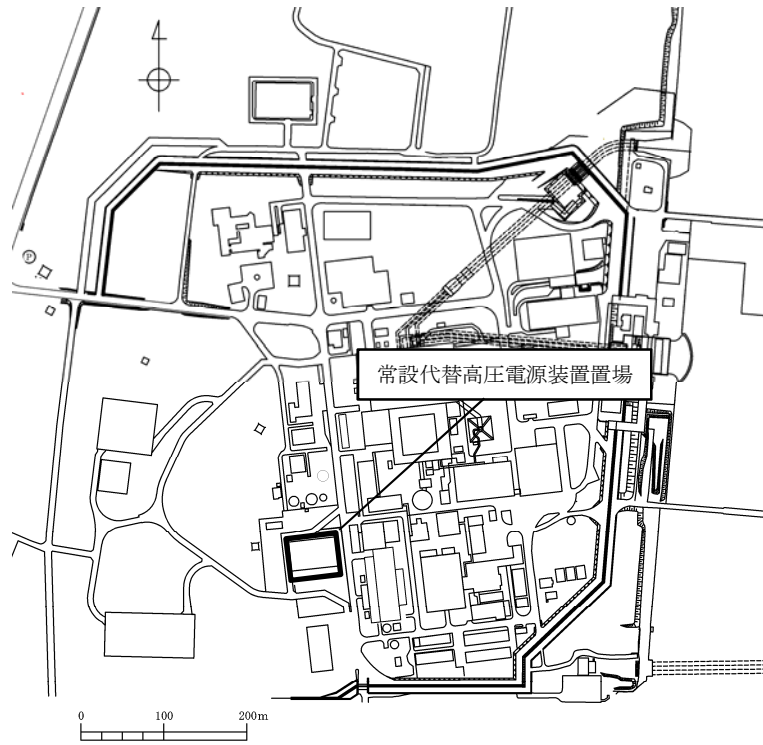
(1) 電源装置置場の平面配置図 (全体平面図)
